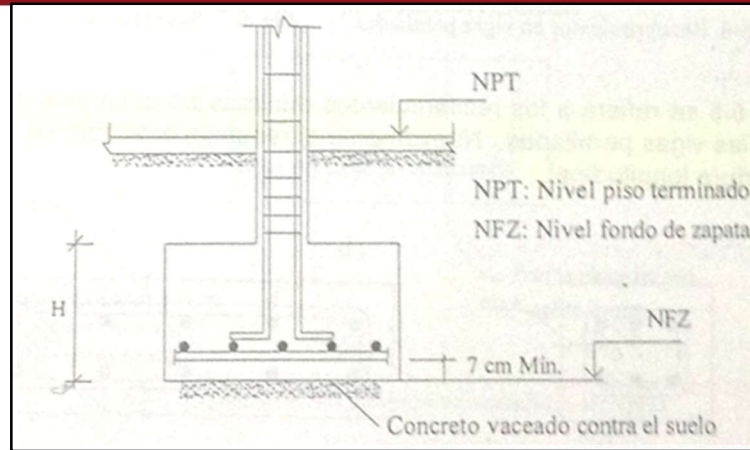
Recubrimiento en Zapatas. (Fuente: Apuntes del Curso Concreto Armado 1, Ottazzi 2010).
